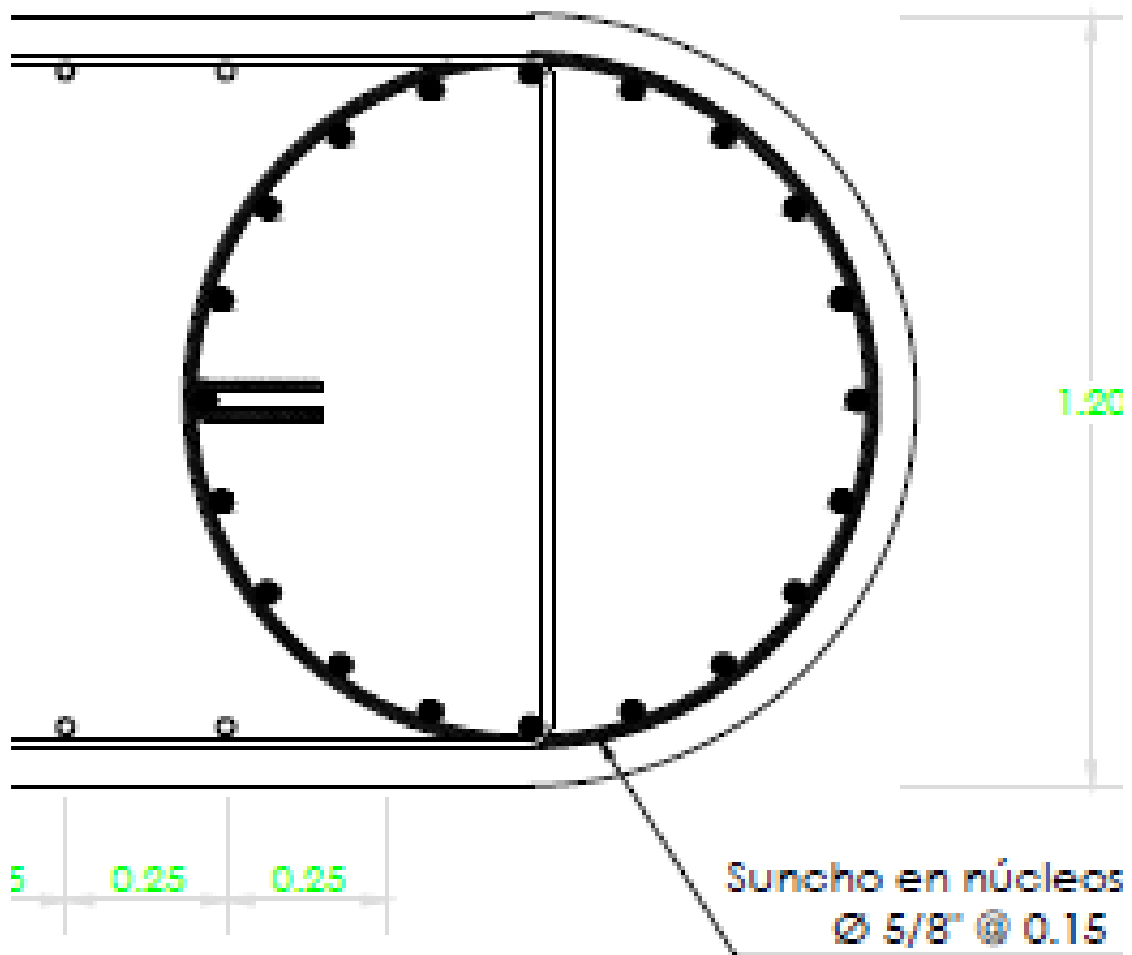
PILAR CENTRAL PUENTE YARAVICO
